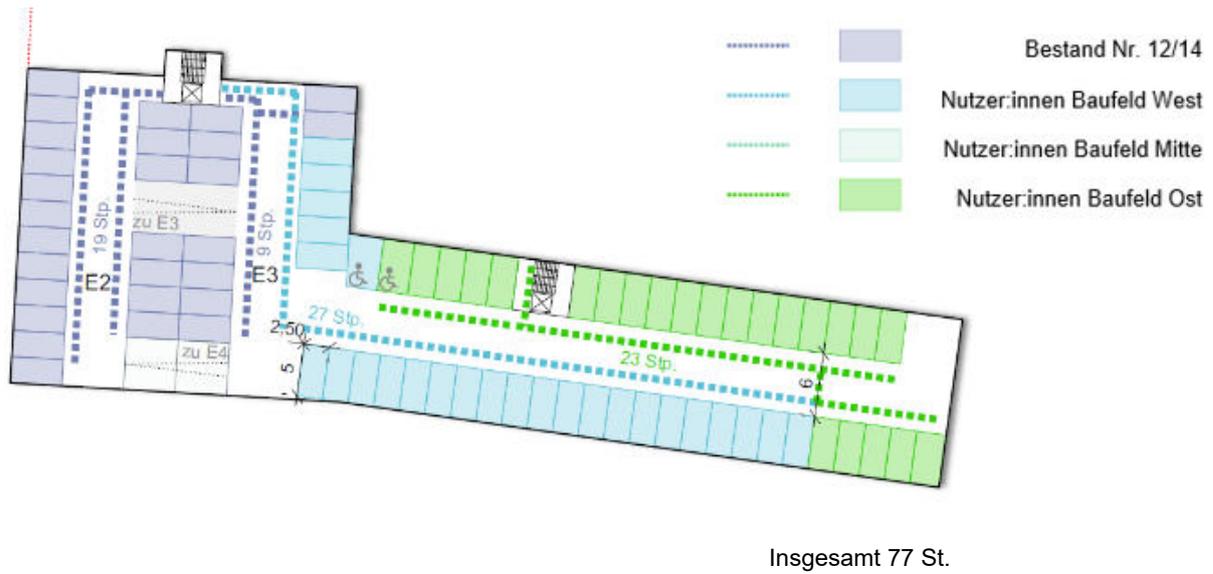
Funktionsgrundriss Parkhaus Ebene E2-E3 (o.M.)
